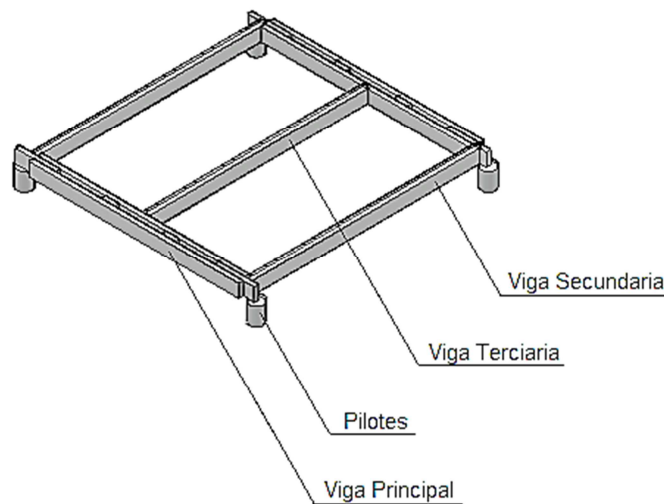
Esquema de la estructura resistente del piso. Fuente: Documentación provista por TECHO.
